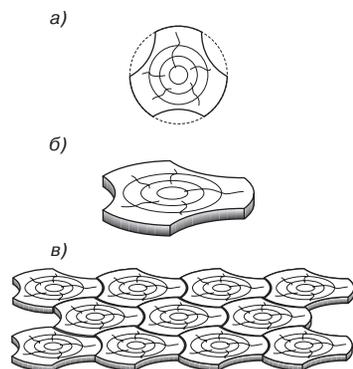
Диагональный паркет: (а) – сечение заготовки; (б) – вид планки сверху; (в) – паркетный пол
